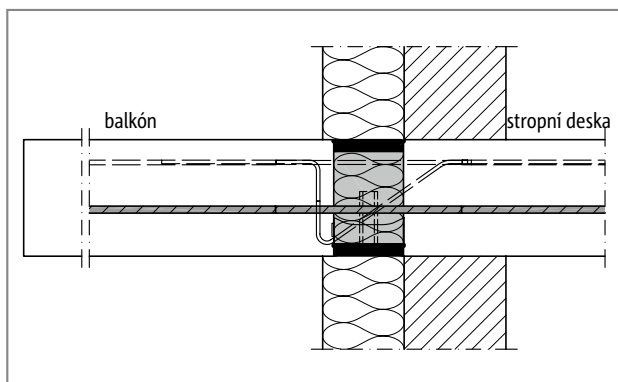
Schöck Isokorb® XT typ HP: Volně vyložený balkón
